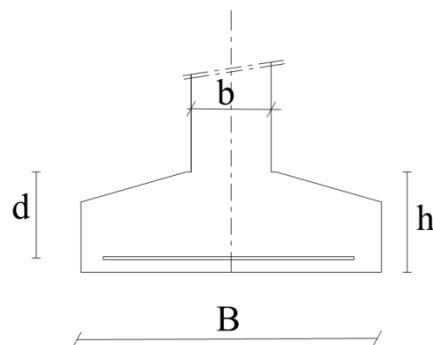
Dimensionnement d'une semelle isolée dans le sens y-y.
